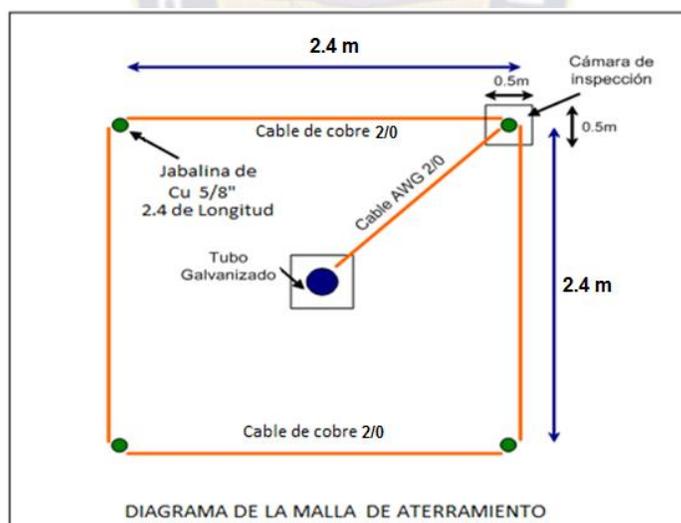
Vista instalación malla de aterramiento³⁹
